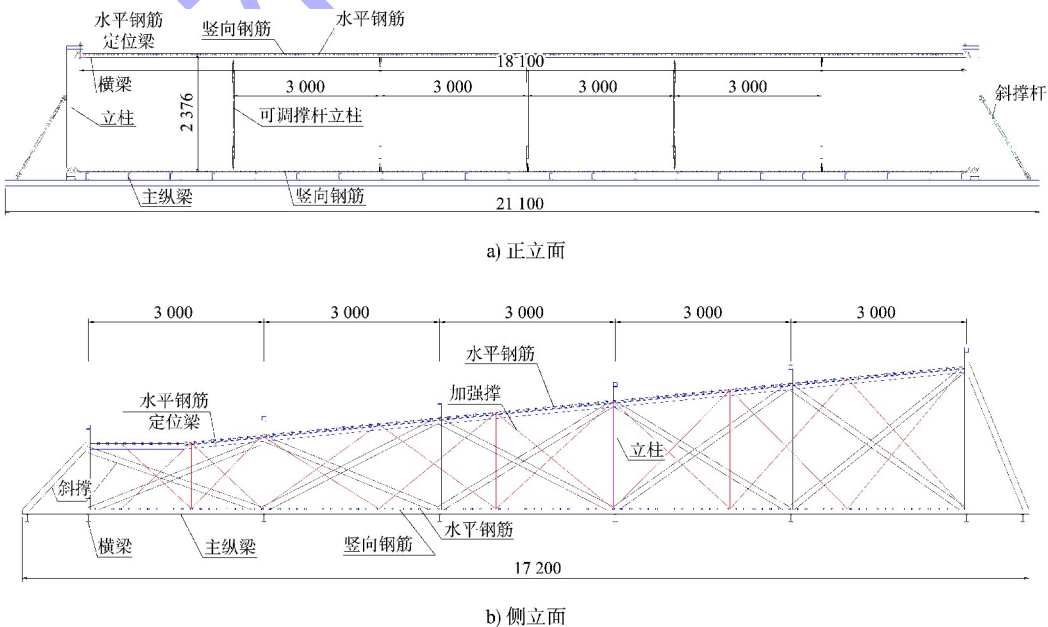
闸室墙钢筋同槽节段预制钢胎架布置 (单位: mm)
